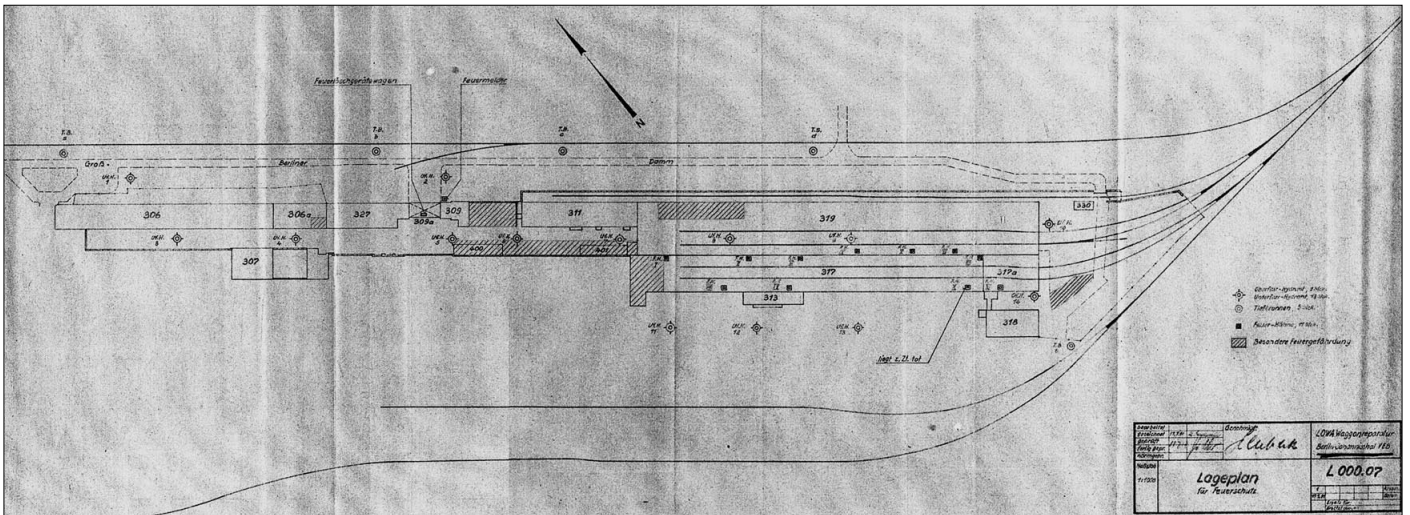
Lageplan vom Juli 1951, hier noch vollständig mit Eisenbahngleisen.
